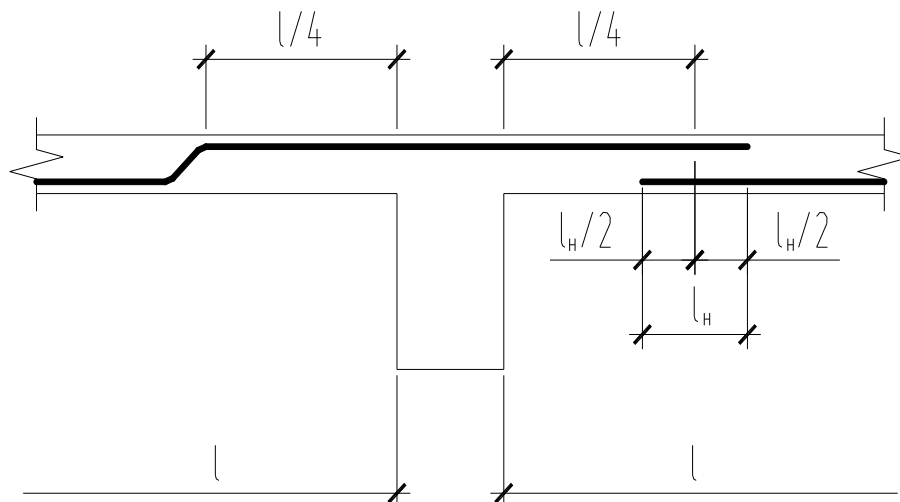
Навпуск арматурних сіток вздовж робочих стрижнів
